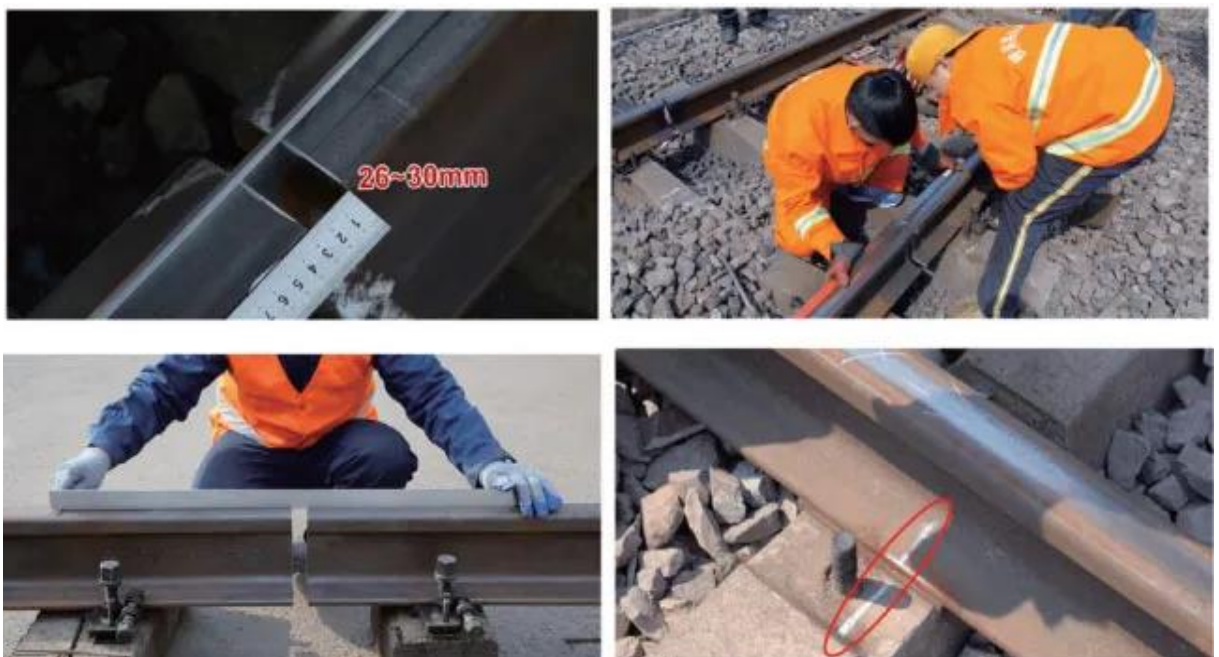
Contrôle Dimensionnel De L'écartement Et Alignement Des Rails Pour La Soudure
